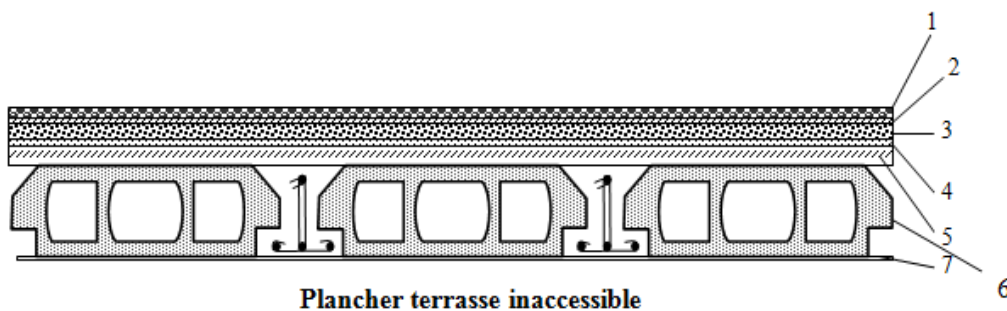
coupe des différentes couches qui composent le plancher de la terrasse.
